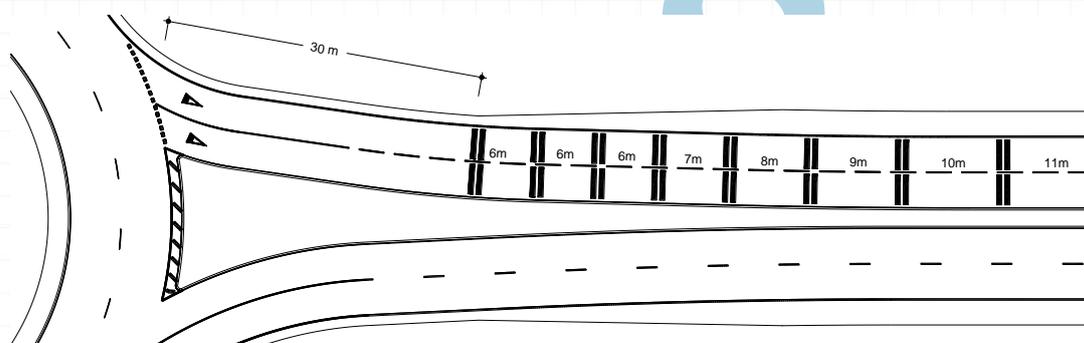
6 - Bandas cromáticas – exemplo de aplicação na aproximação a uma rotunda
